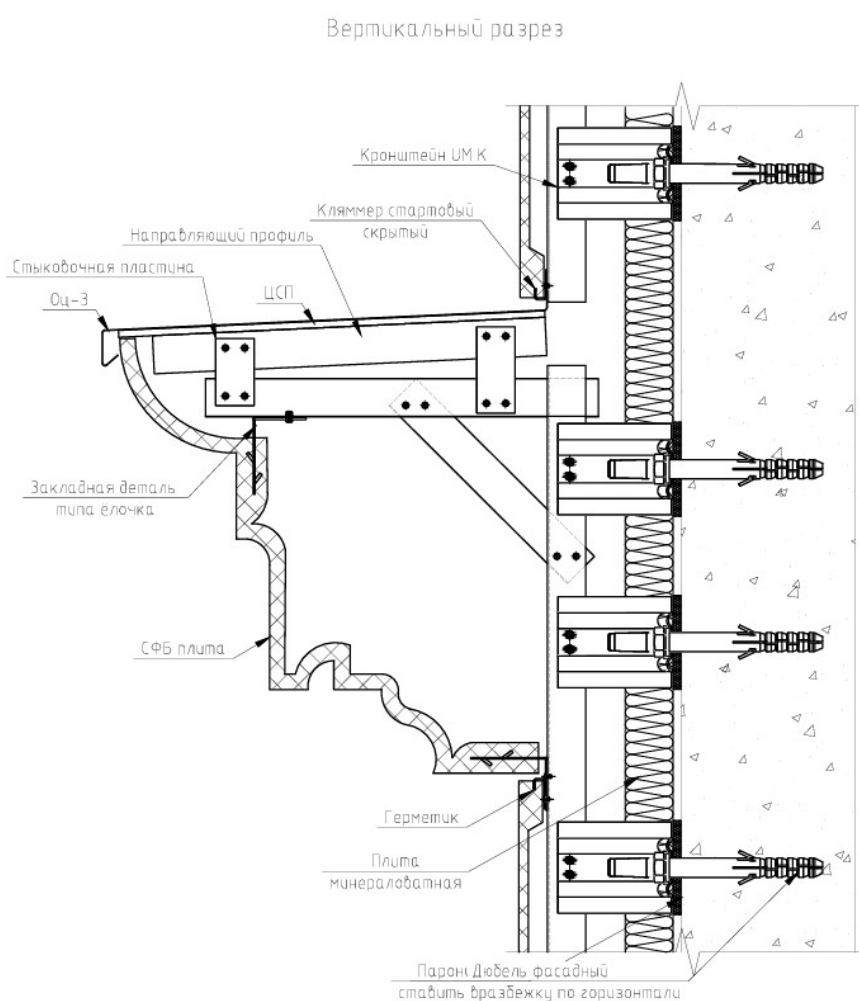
Крепление облицовки с помощью закладных деталей распорного вида
